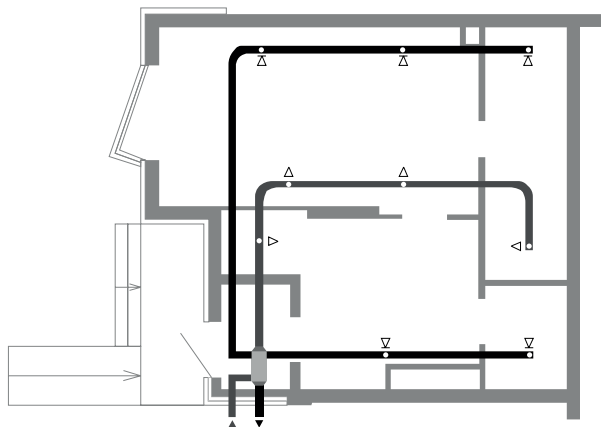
Пример схемы монтажа и разведения воздуховодов приточно-вытяжной системы вентиляции «PRANA-340S».
